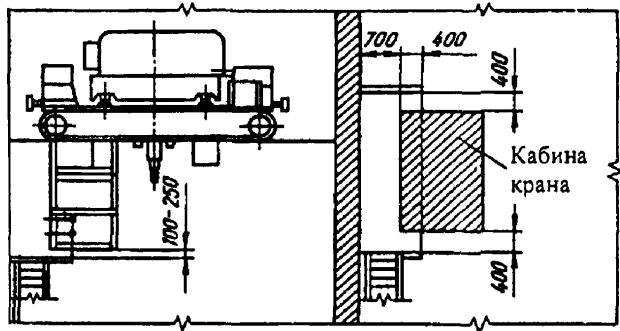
Схема посадочной площадки (вариант 2).
